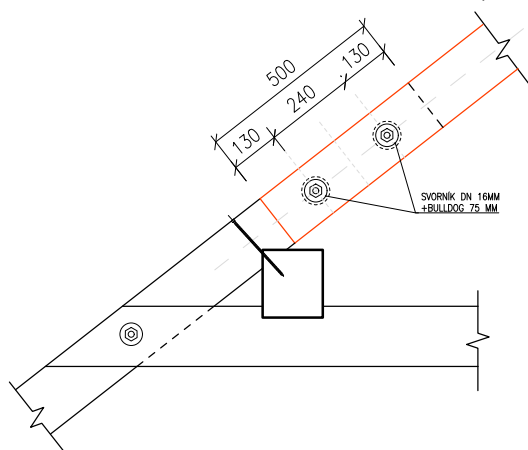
## DETAIL PLÁTOVÁNÍ VAZNÝCH TRÁMŮ :
